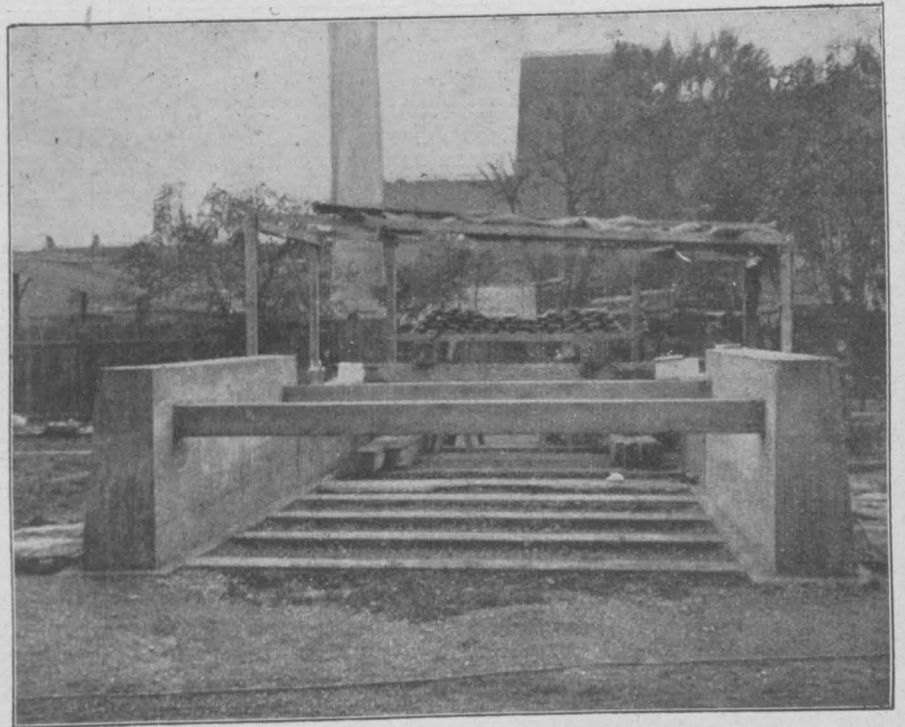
Widerlager mit eingemauerten Balken in Betonwiderlagern.
